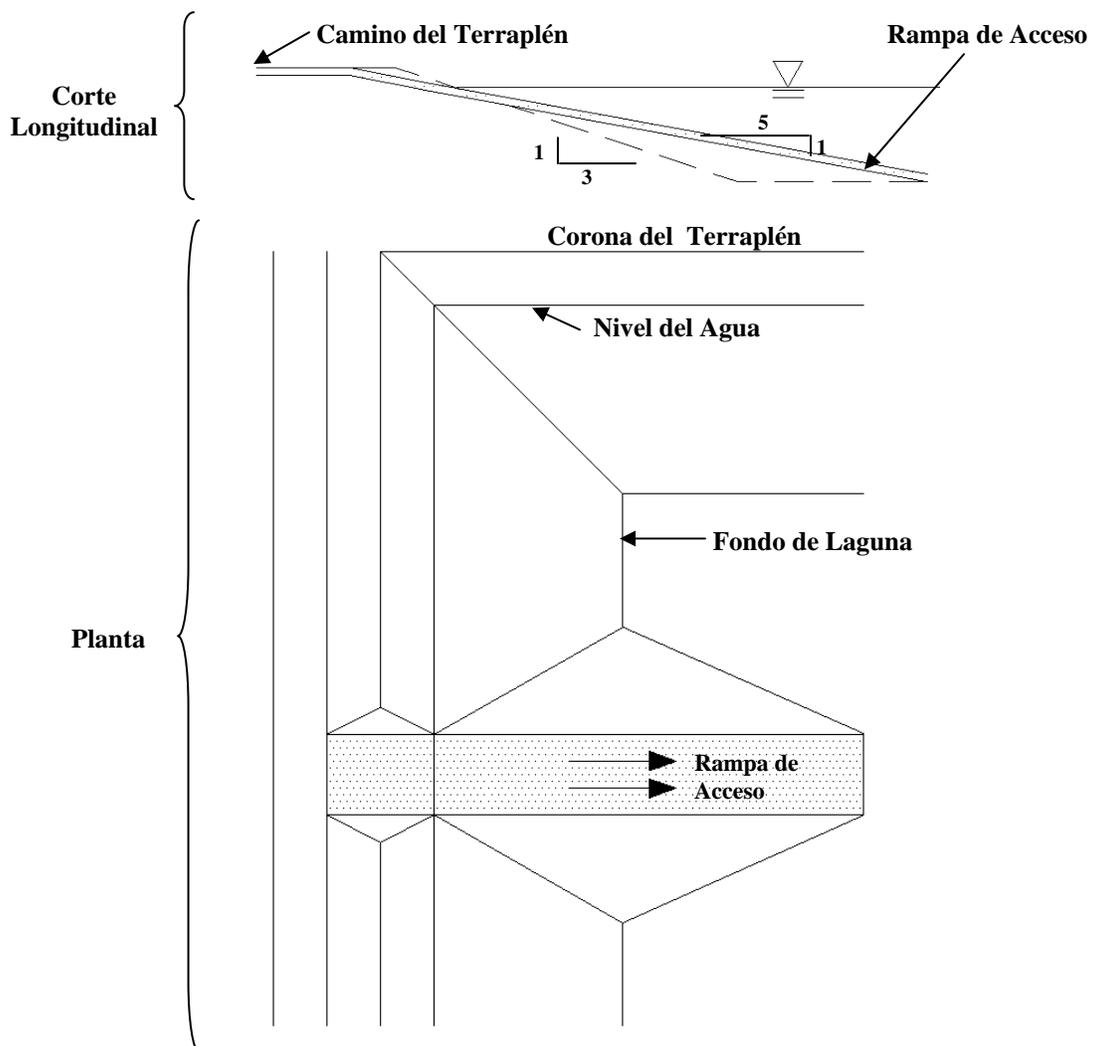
Cada laguna primaria debe incluir rampas de acceso hasta al fondo para maquinaria como cargadores frontales y volquetas para permitir la remoción de lodos. Las rampas tienen que ser pavimentadas para que la maquinaria tenga tracción sin dañar la impermeabilización y taludes de la laguna.
